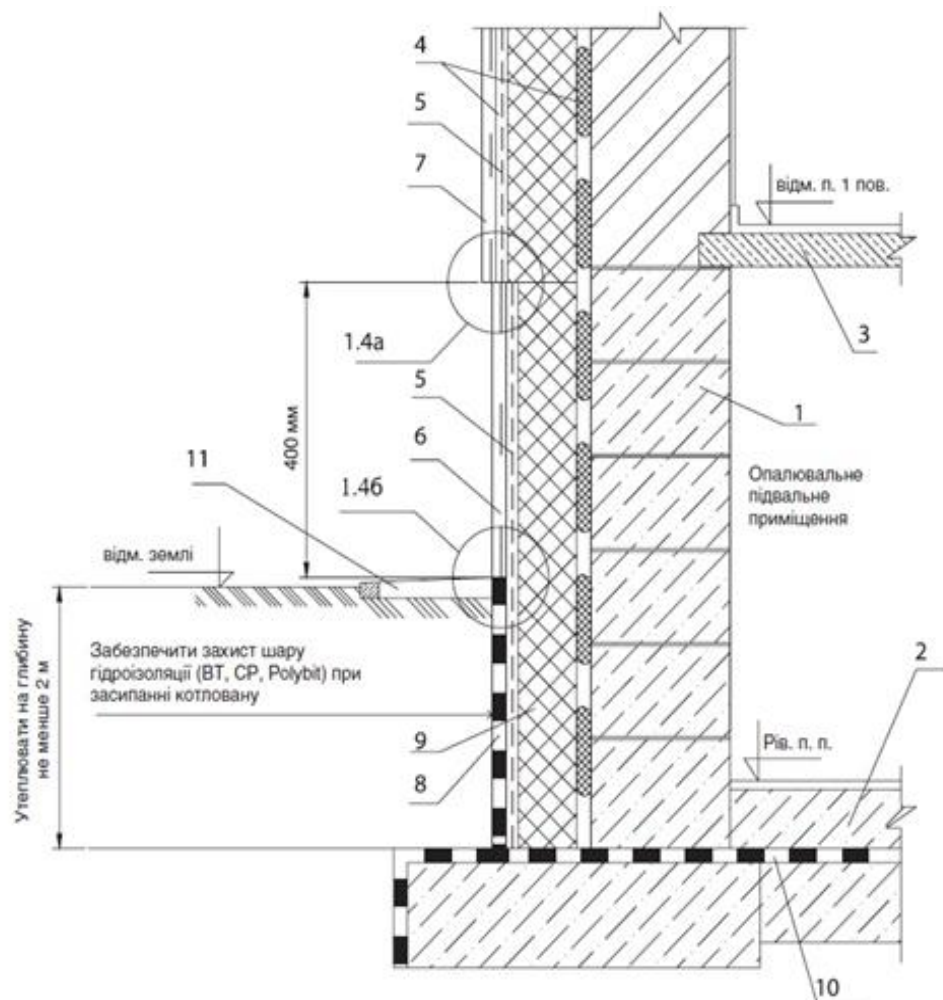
Схема утеплення підвальної частини будівлі з поверхневим скидом дощової вод
